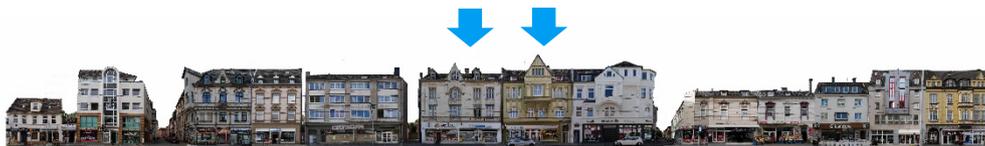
Fassadenabwicklung Bestand Hochstraße 12 – 36
